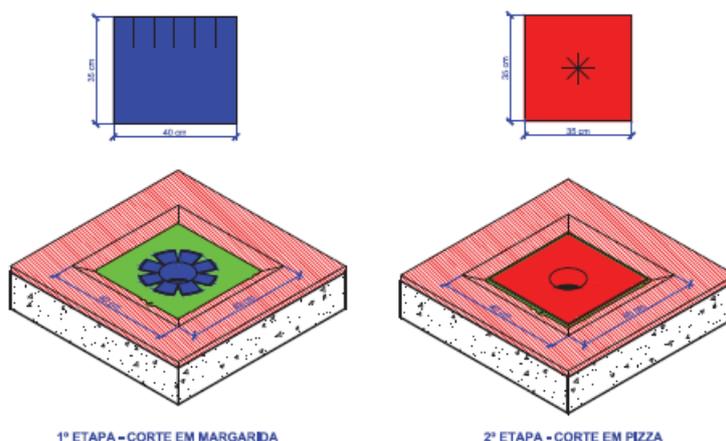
Aplicação de manta em corte margarida seguido de corte em pizza. Fonte: VEDACIT (2016)
